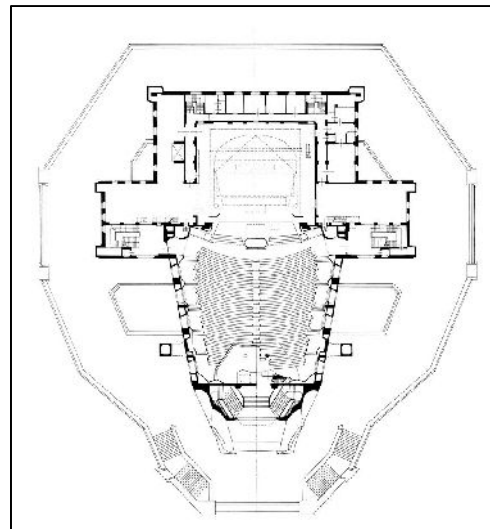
Il secondo Goetheanum. Vista in pianta.
